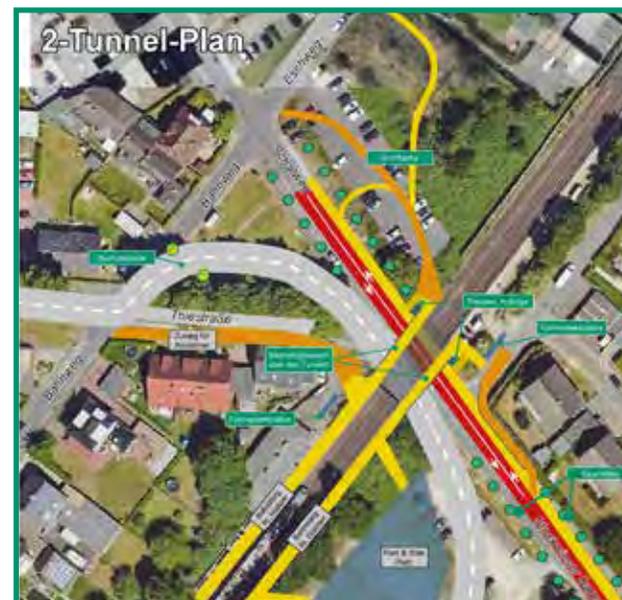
2-Tunnel-Plan Luftbildmontage
